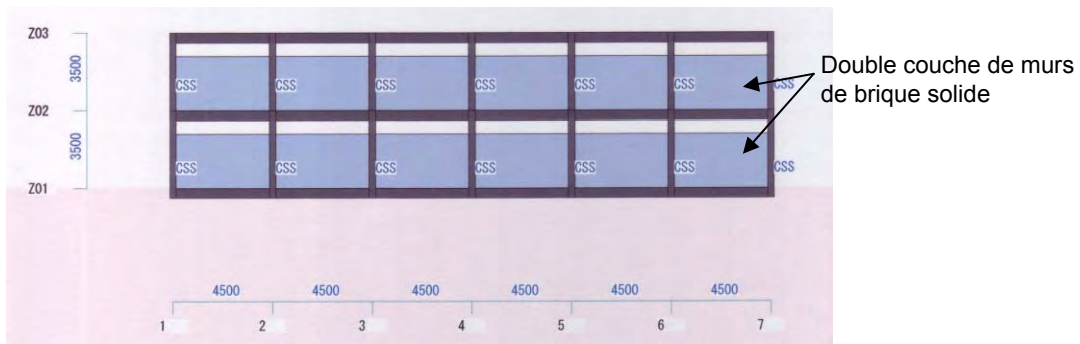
Plan d'ossature du 2e niveau de la maille A
